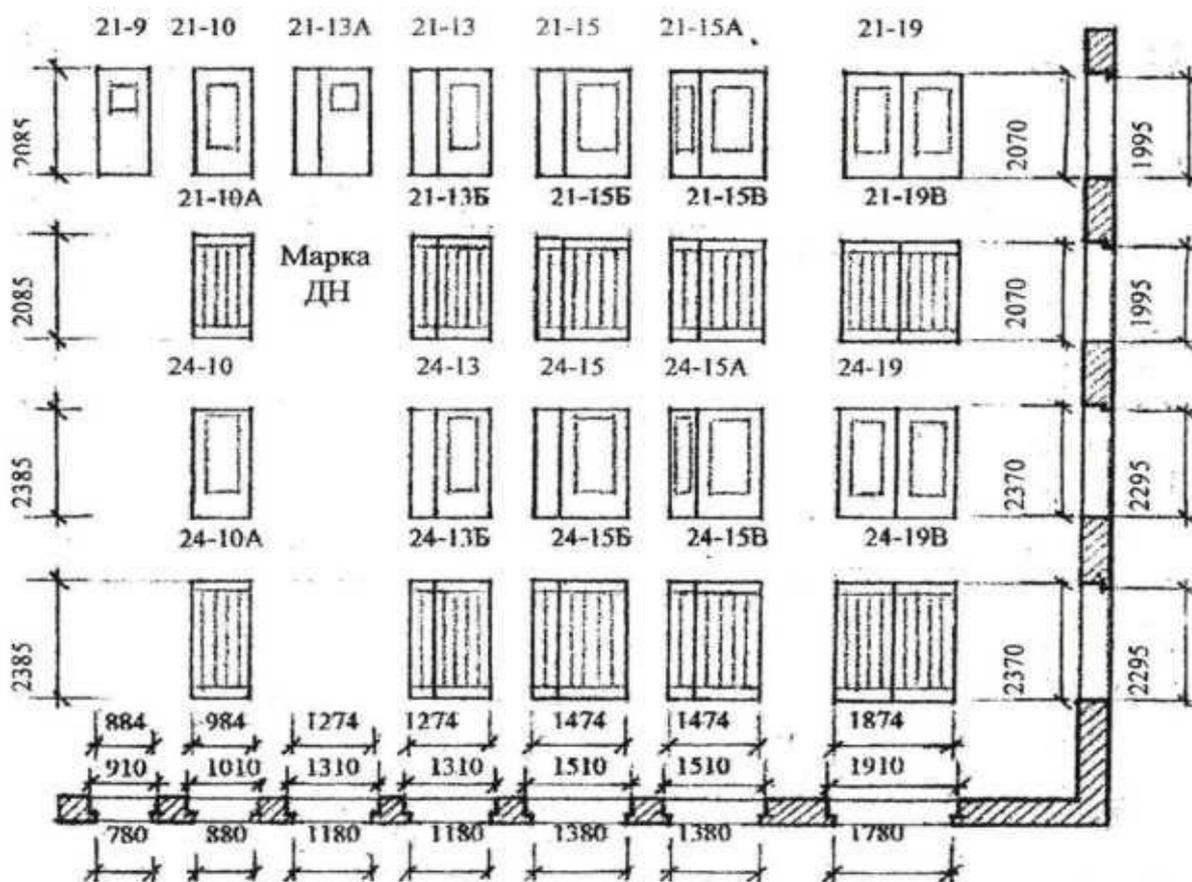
Типовые размеры дверных блоков марки ДГ;
